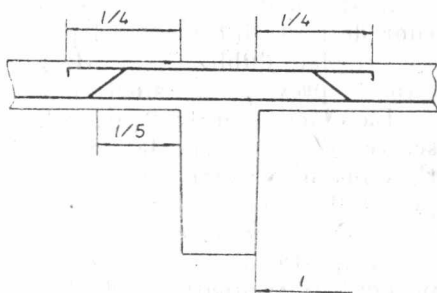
Distanțe constructive pentru bare ridicate.
